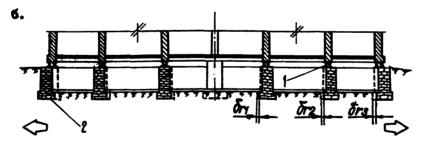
Схема смещения фундаментов тордовых и поперечных стен здания, не усиленного фундаментными поясами:
